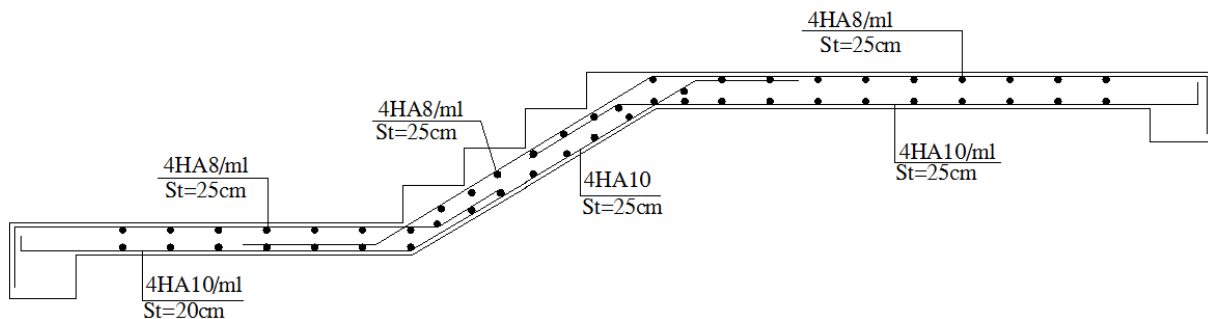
schéma de ferrailage de l'escalier (volée DE)
